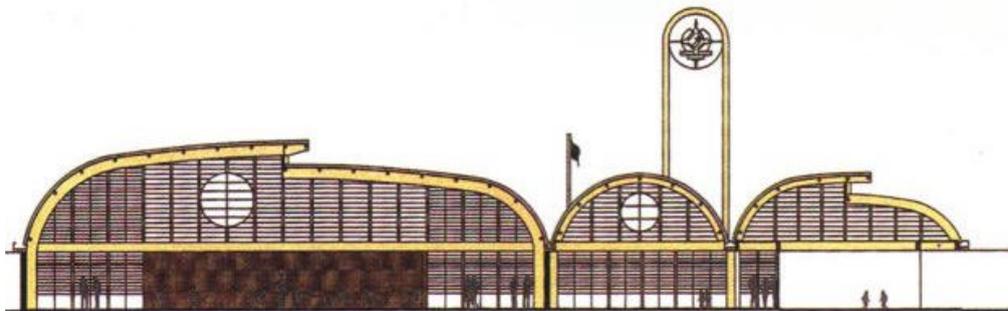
Corte esquemático mostrando o sistema de ventilação da cobertura.
